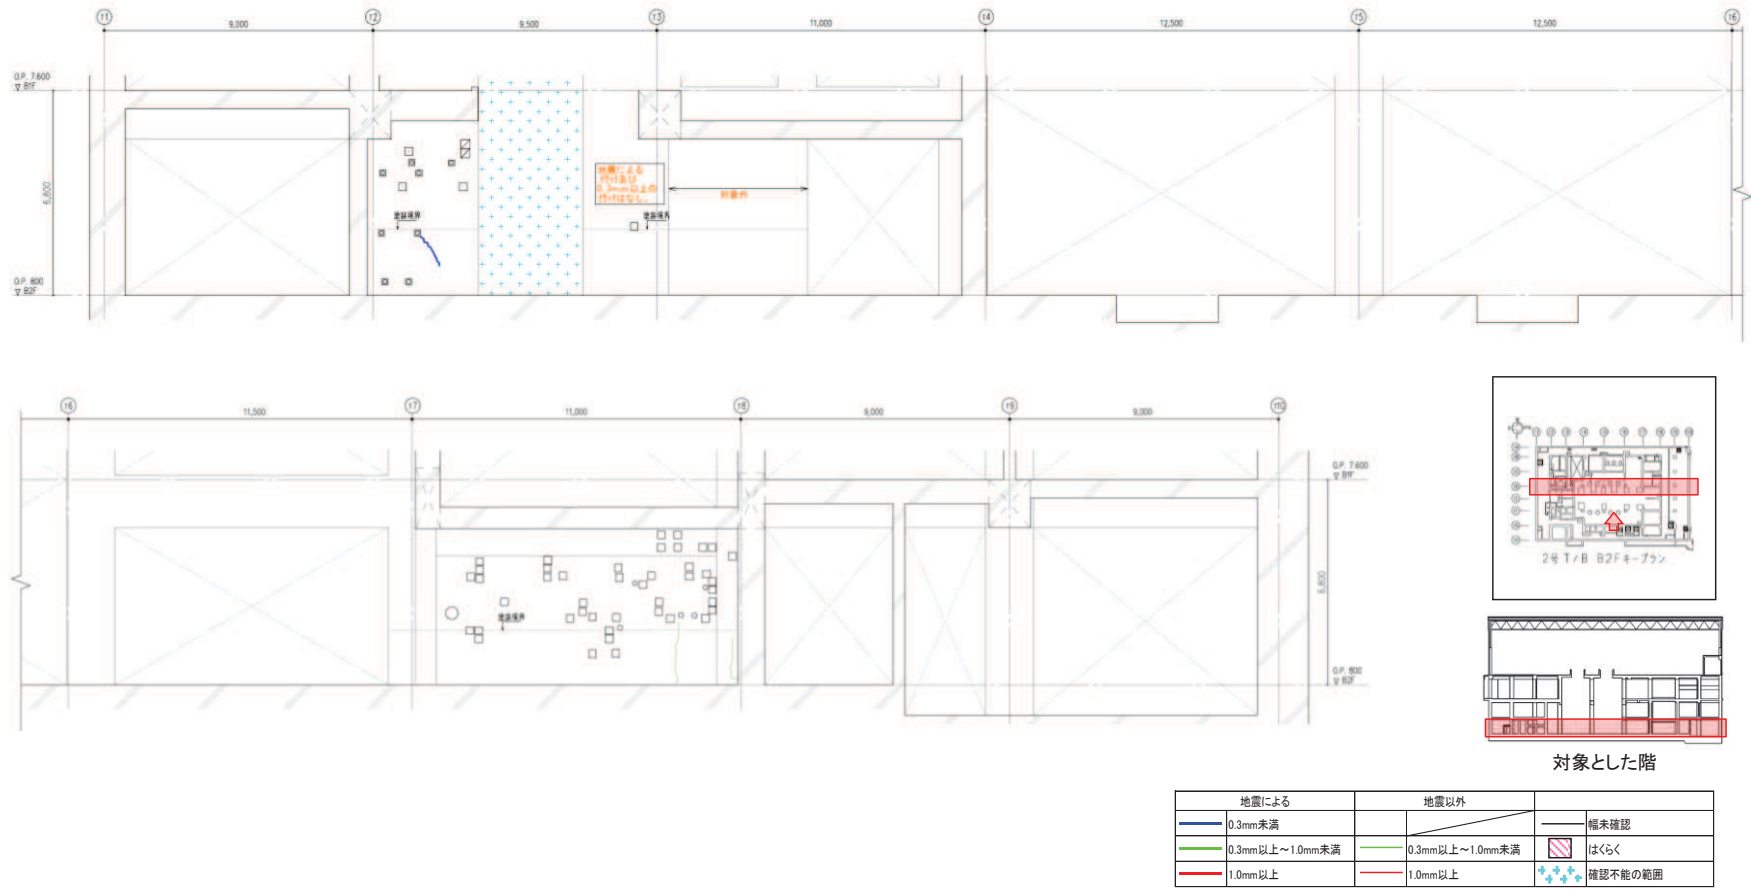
タービン建屋のひび割れ分布 耐震壁 (13) 地下 2 階 TD 通り
